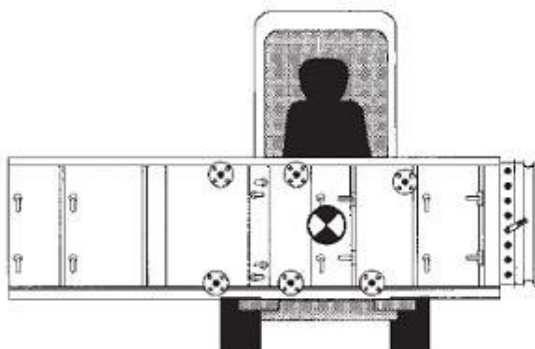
Tyngdepunktet placeret centralt mellem gaflerne
